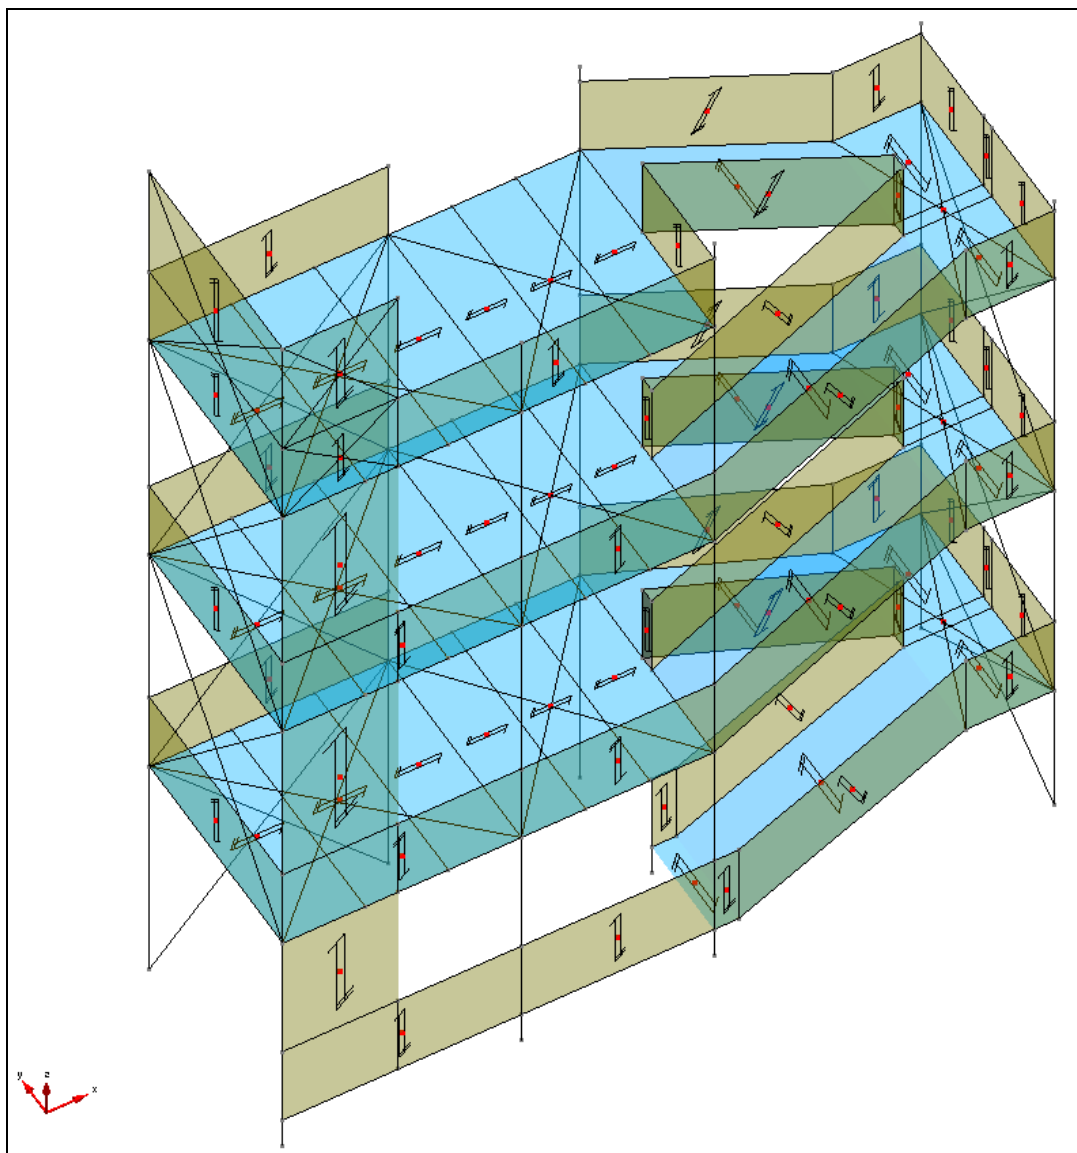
ELEMENTI SOLAIO PER PIANEROTTOLI E PARAPETTI
